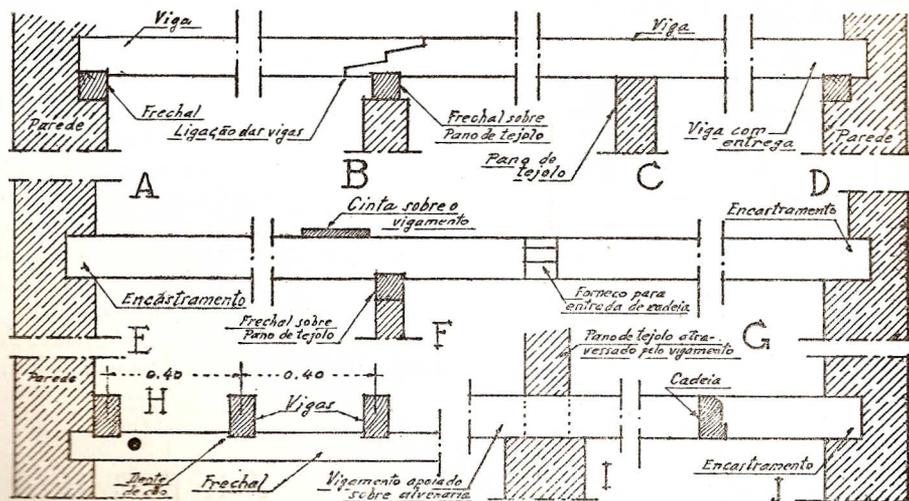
ASSENTAMENTO DE VIGAS SOBRE FRECHAIS E ENCASTRADAS
